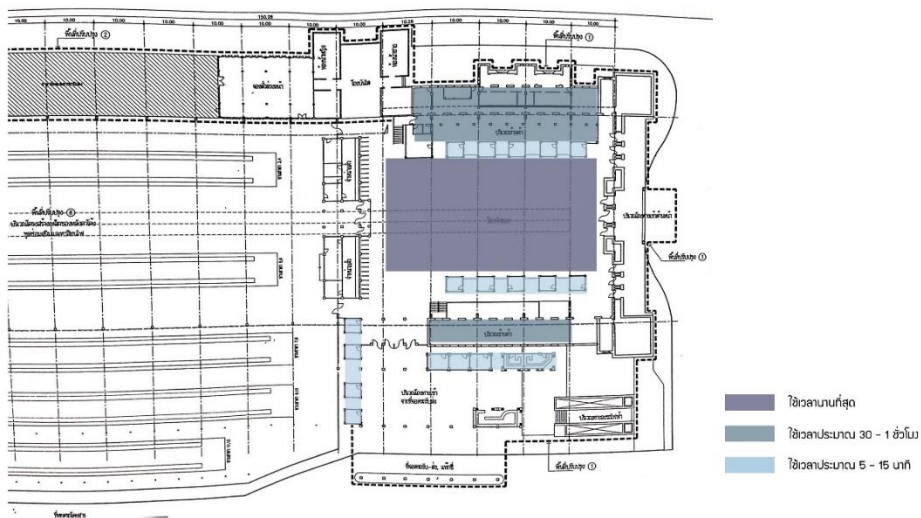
zoning plan เดิมของสถานีรถไฟฟ้ากรุงเทพ
